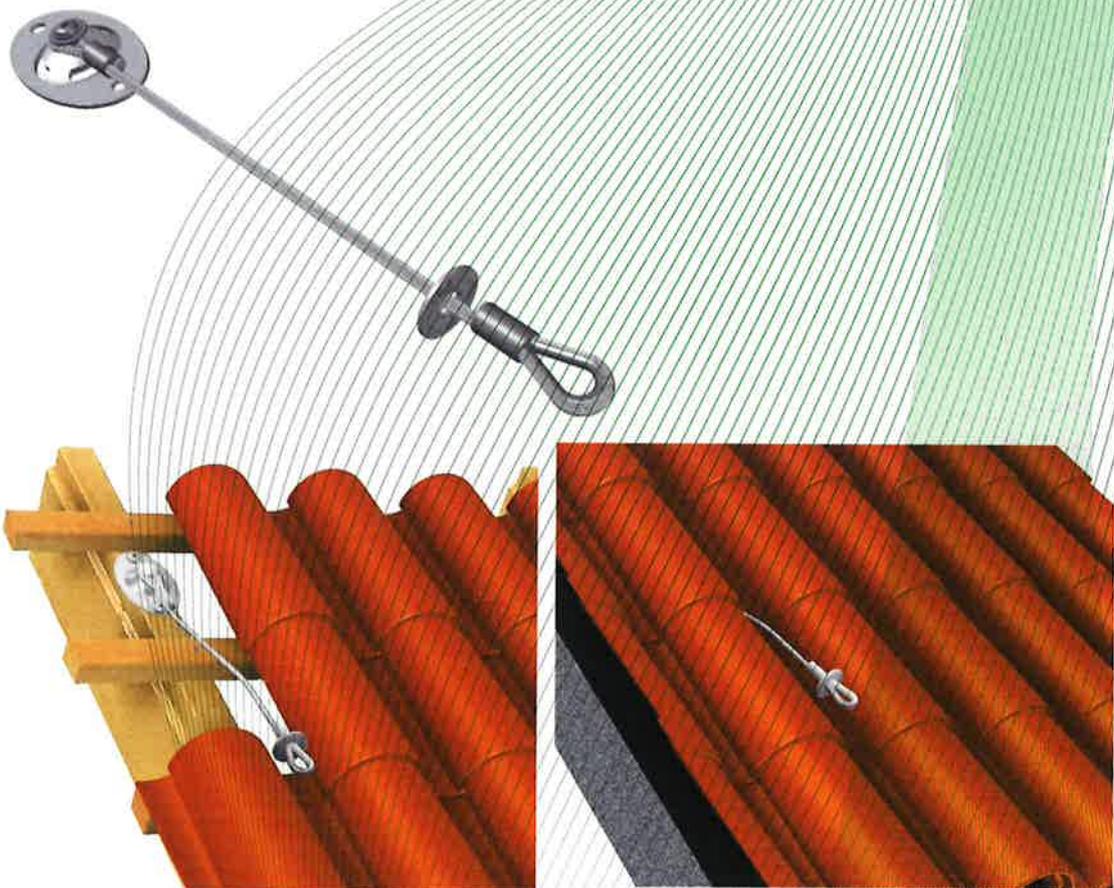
Anschlageinrichtung, Typ: LUX-top® CORDA
